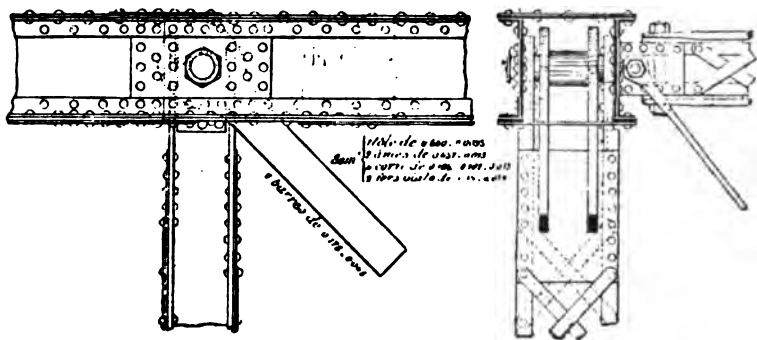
Pont de Bismarck. Nœud S_2 de la semelle supérieure,
